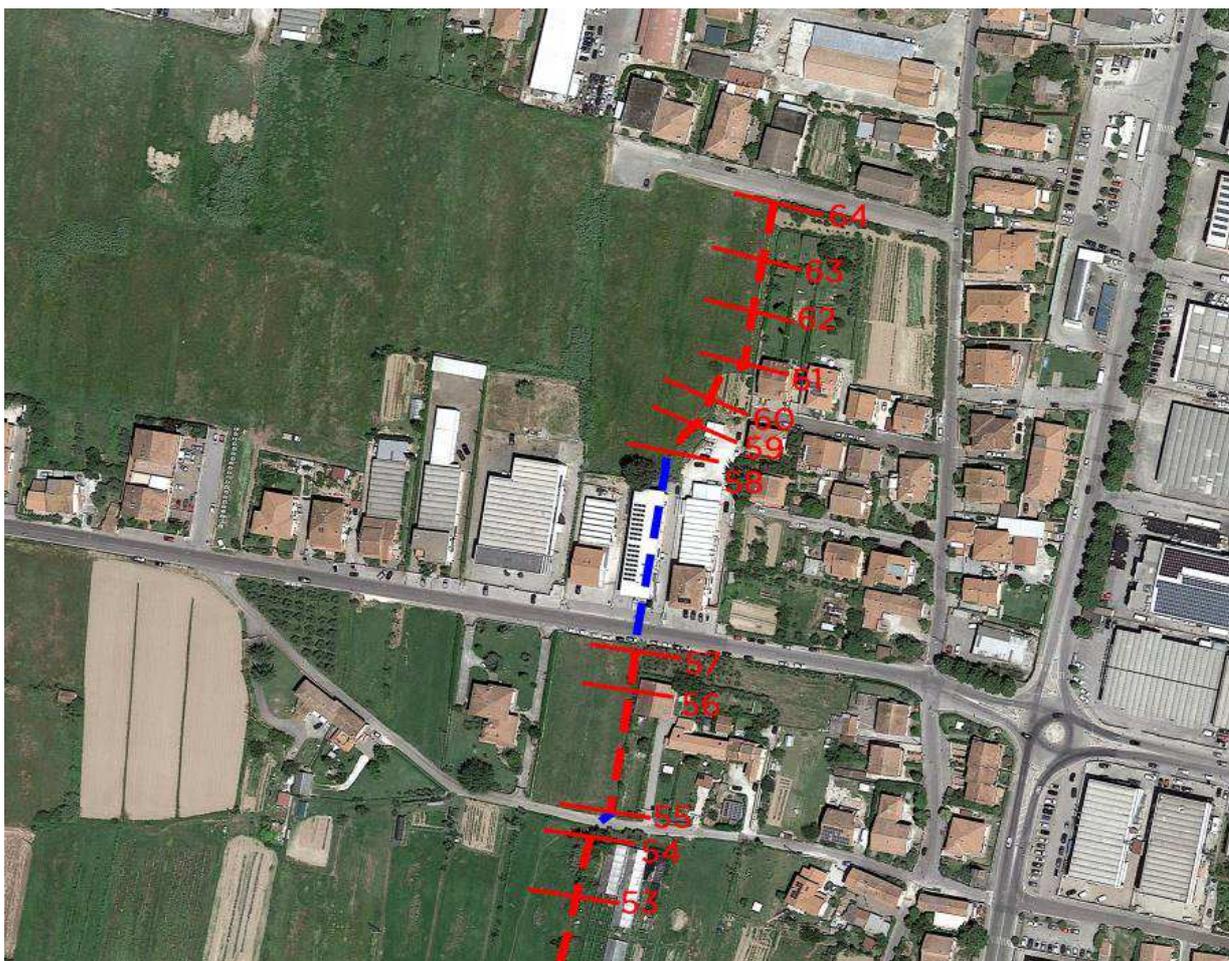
Andamento planimetrico Fosso Arrù come da rilievo topografico
